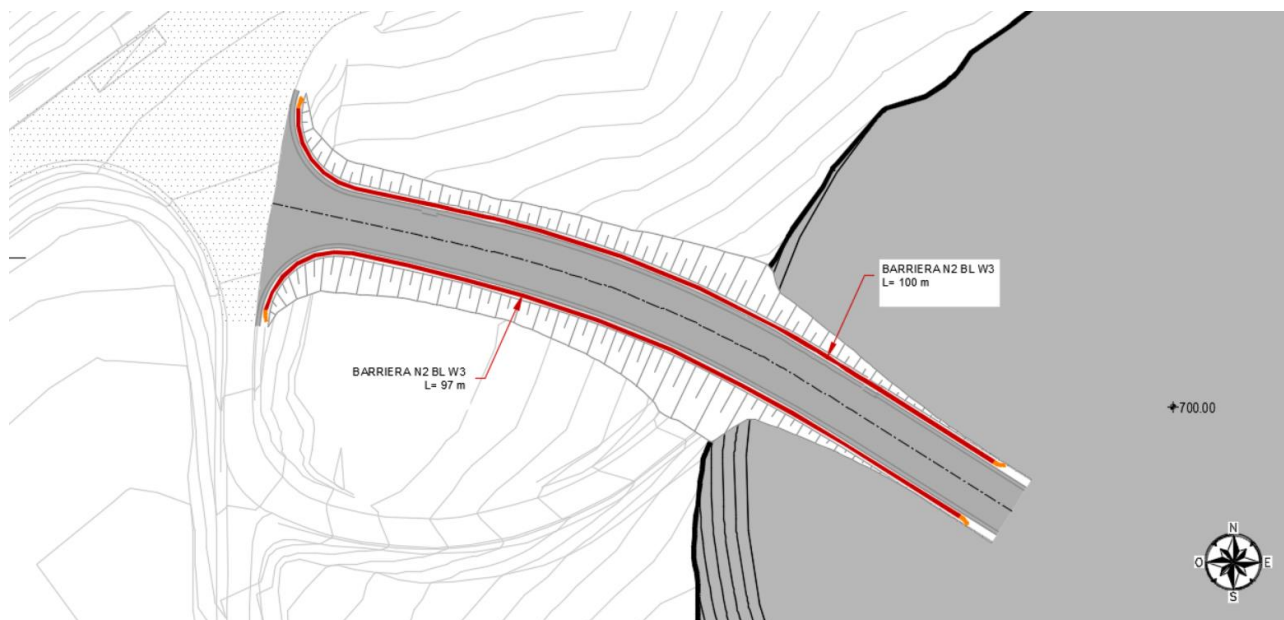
Stralcio planimetrico del progetto delle barriere di sicurezza
